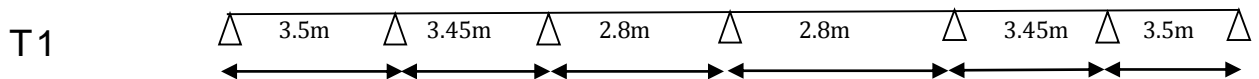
1 : Schémas de disposition des poutrelles du plancher 16+4
